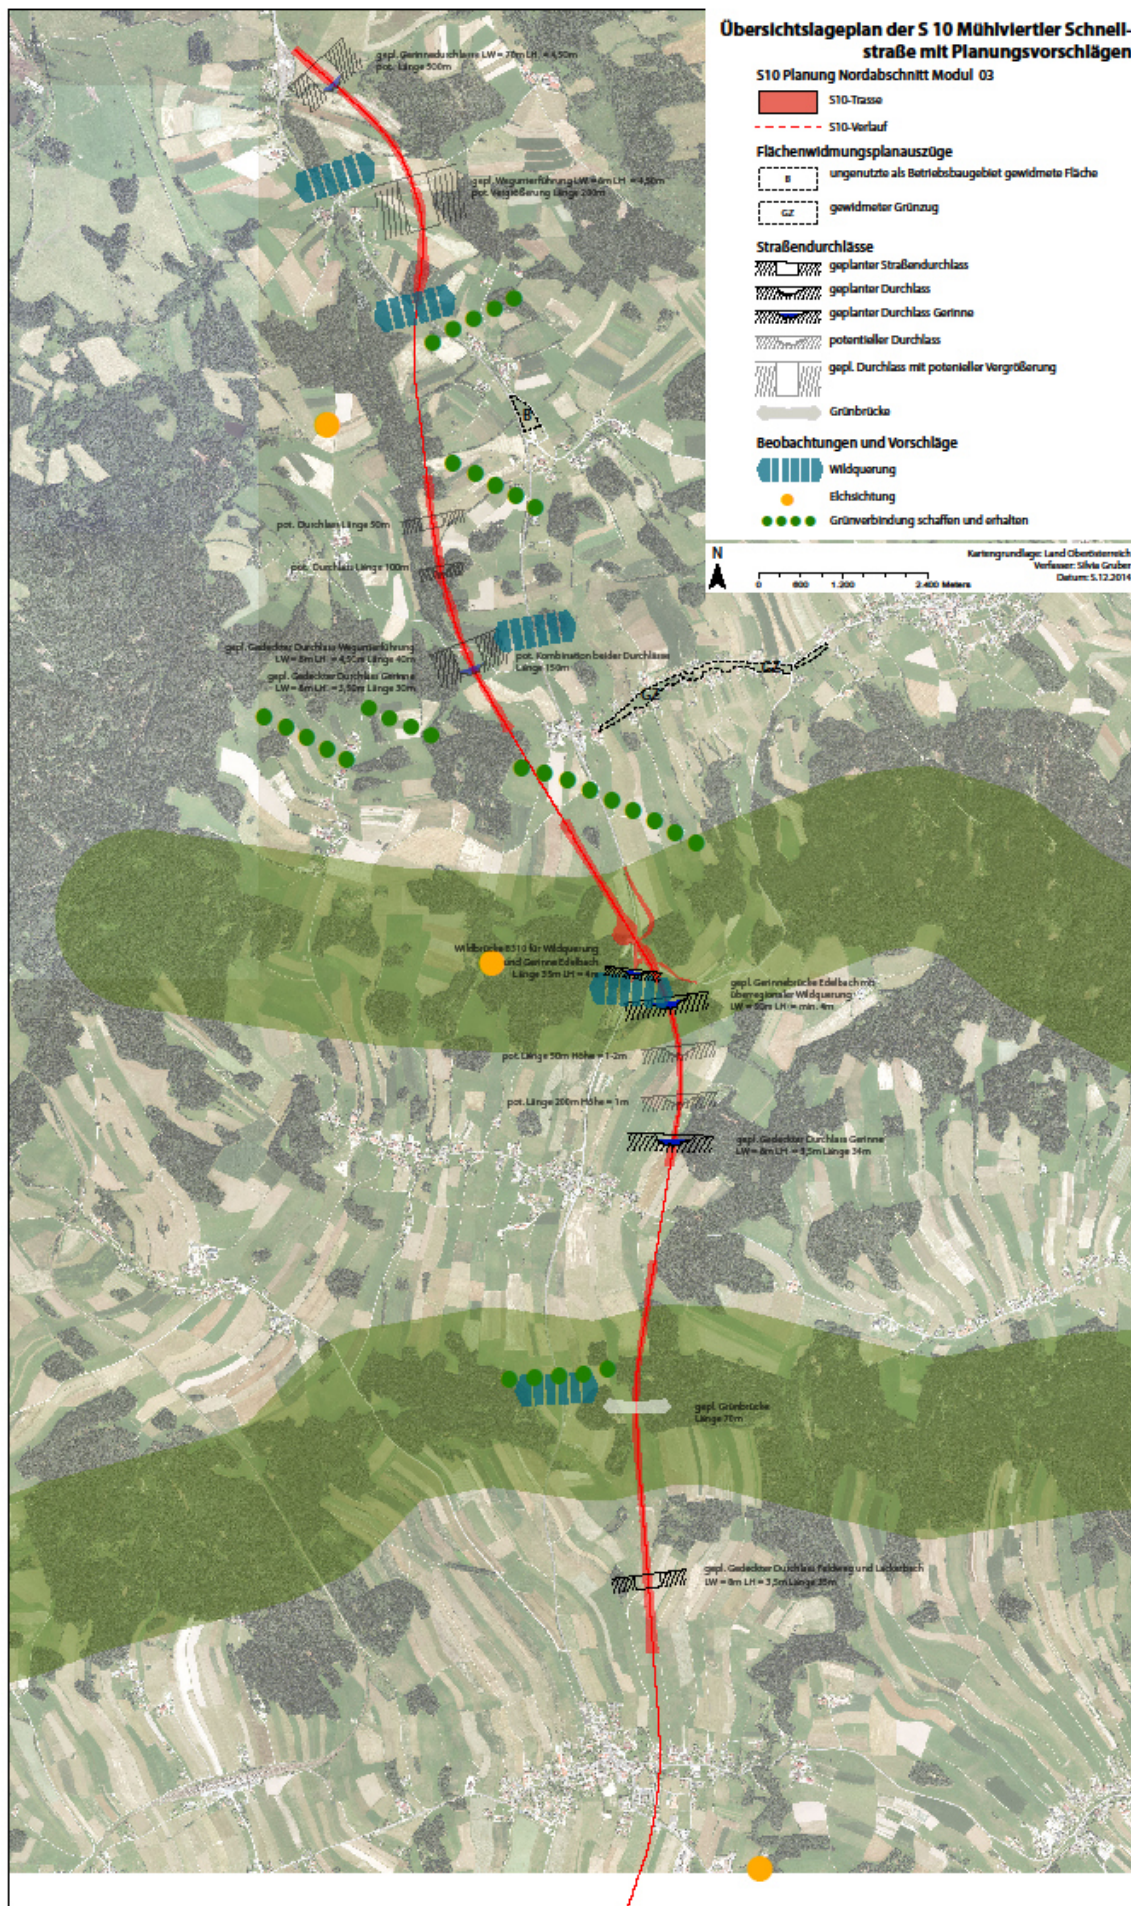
Übersichtslageplan der S10 Mühlviertler Schnellstraße inklusive Planungsvorschlägen für potenzielle Durchlässe.
